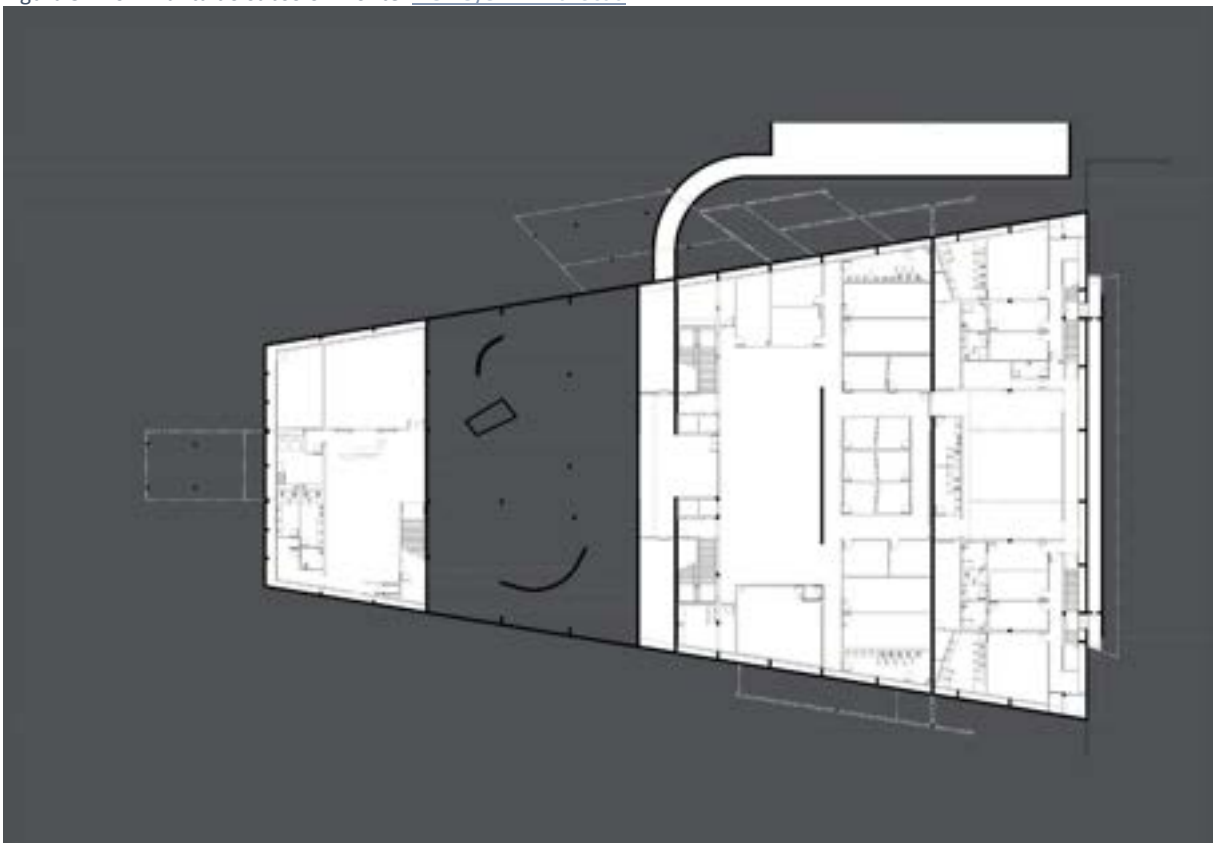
Planta térreo – Fonte: [niemeyer](#) — Bibliocad
